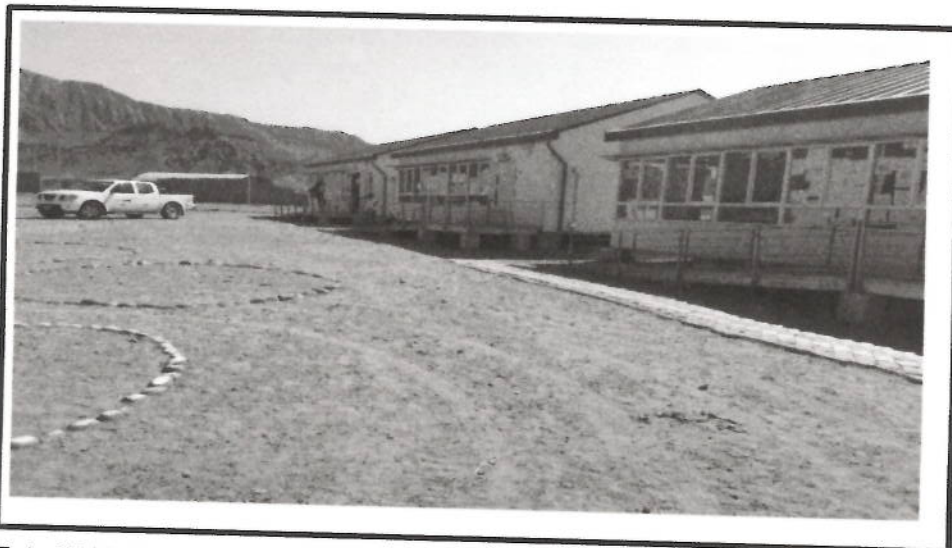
Vista de Pabellón 01-Modulos instalados por contratista NEXCOM
